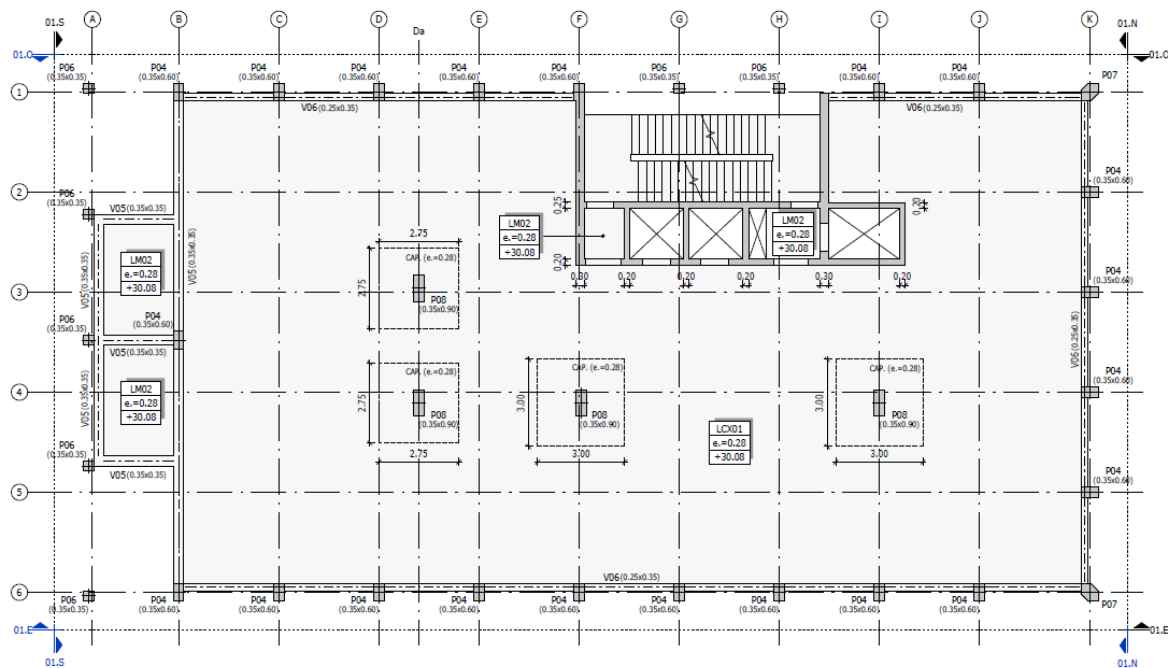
Planta estrutural Pisos Ímpares (Revit)
